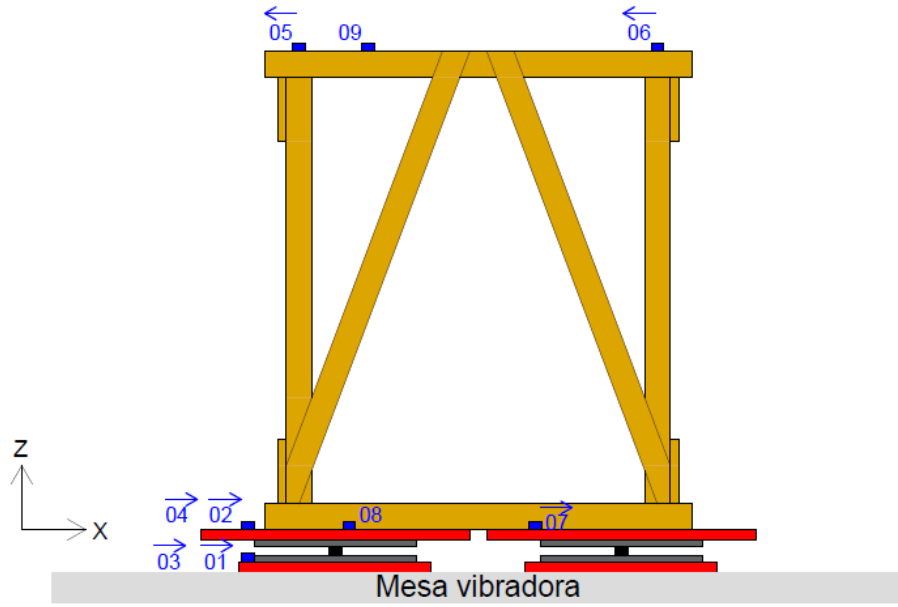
Croquis de vista en planta de estructura aislada instrumentada en mesa vibradora, plano XZ.
